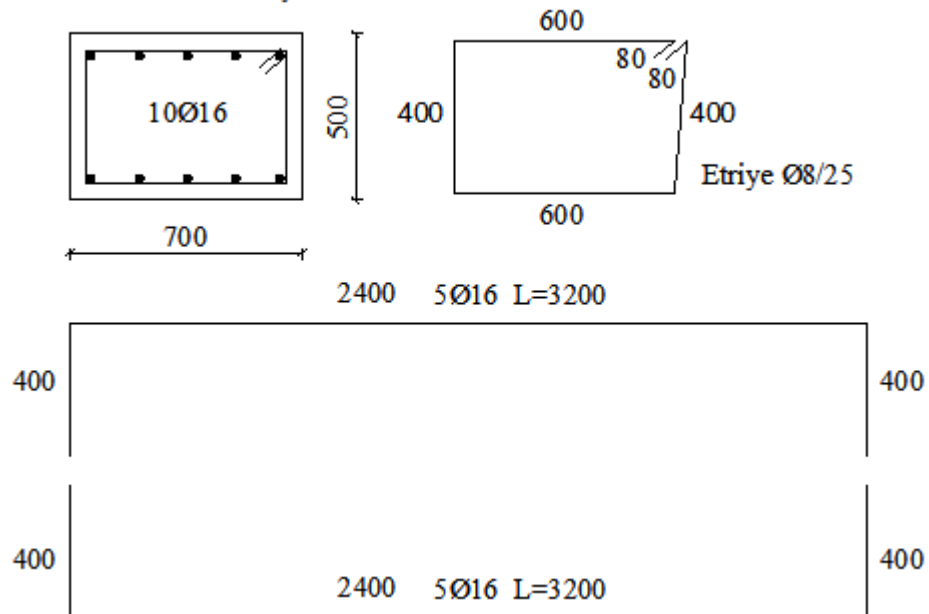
Betonarme çerçeveye ait kiriş kesit ve donatı detayları
